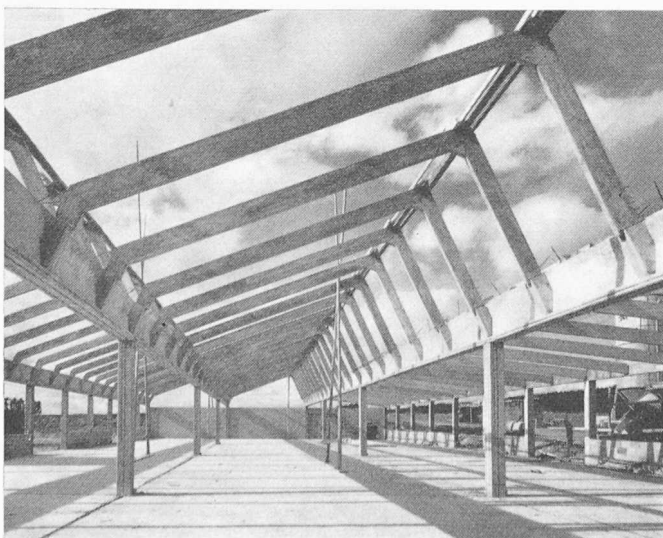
Sheddalle mit Spannbetonbindern und Dreieckrahmen
